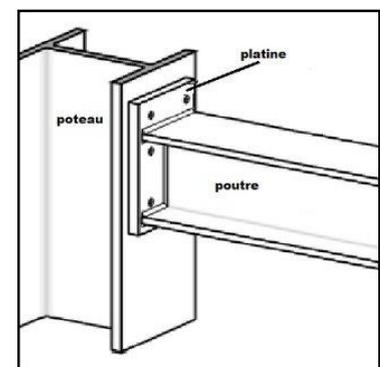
Schéma d'un assemblage d'une poutre avec un poteau métallique.
